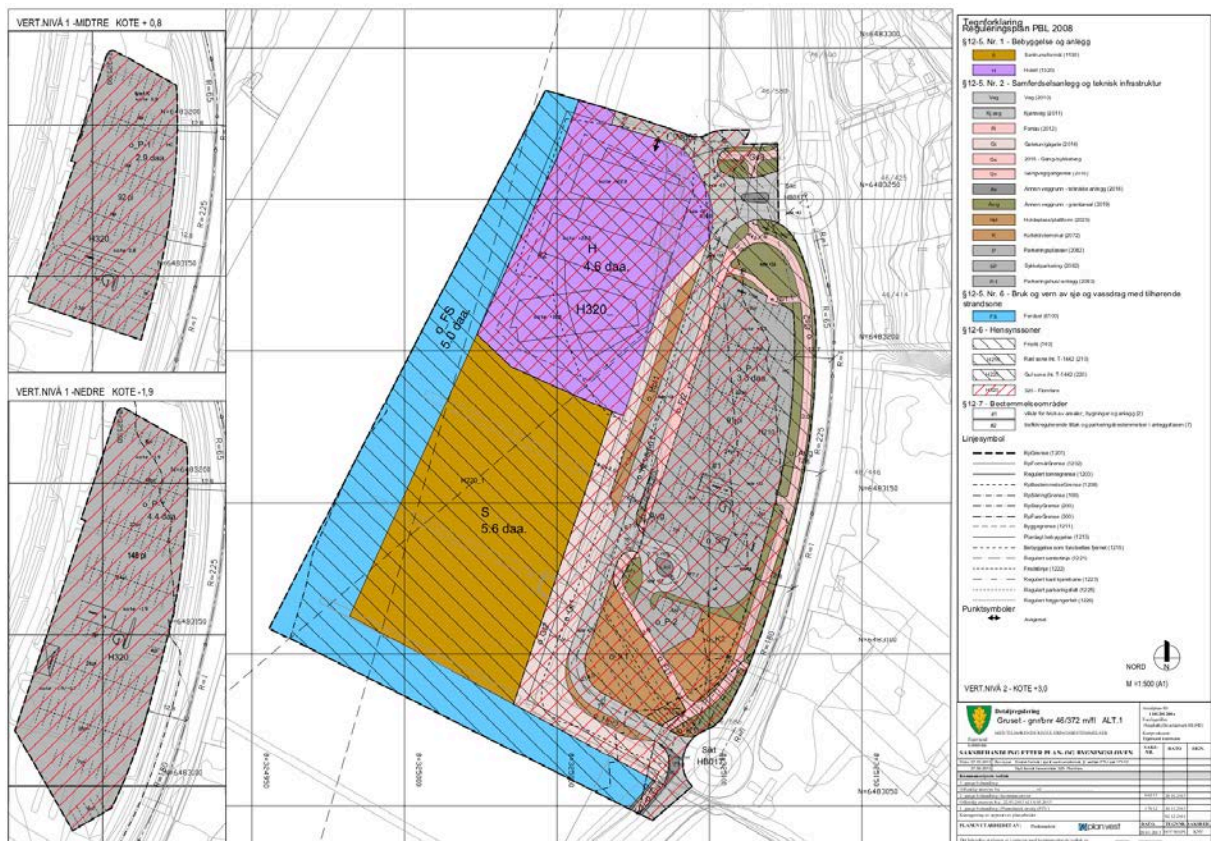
Gjeldende plan. Detaljregulering vedtatt 28.10.2013.
